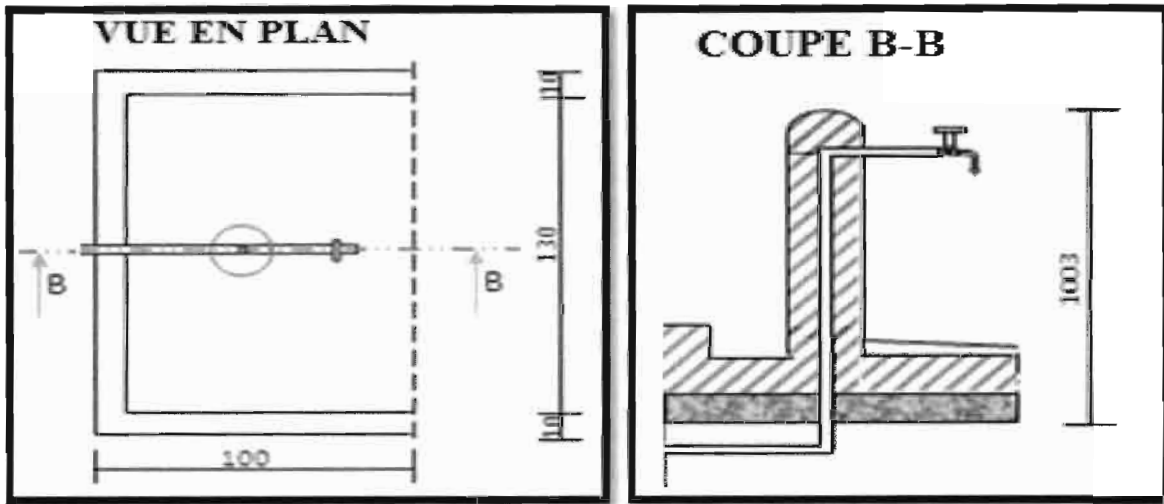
Vue en plan et coupe d'une borne fontaine
